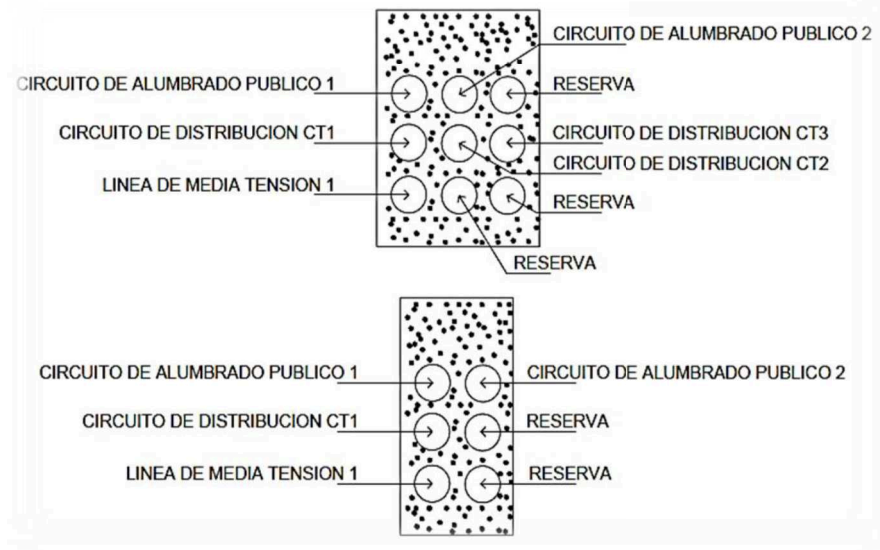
Banco de ductos para ingreso de cables a la Cabina Subterránea.
